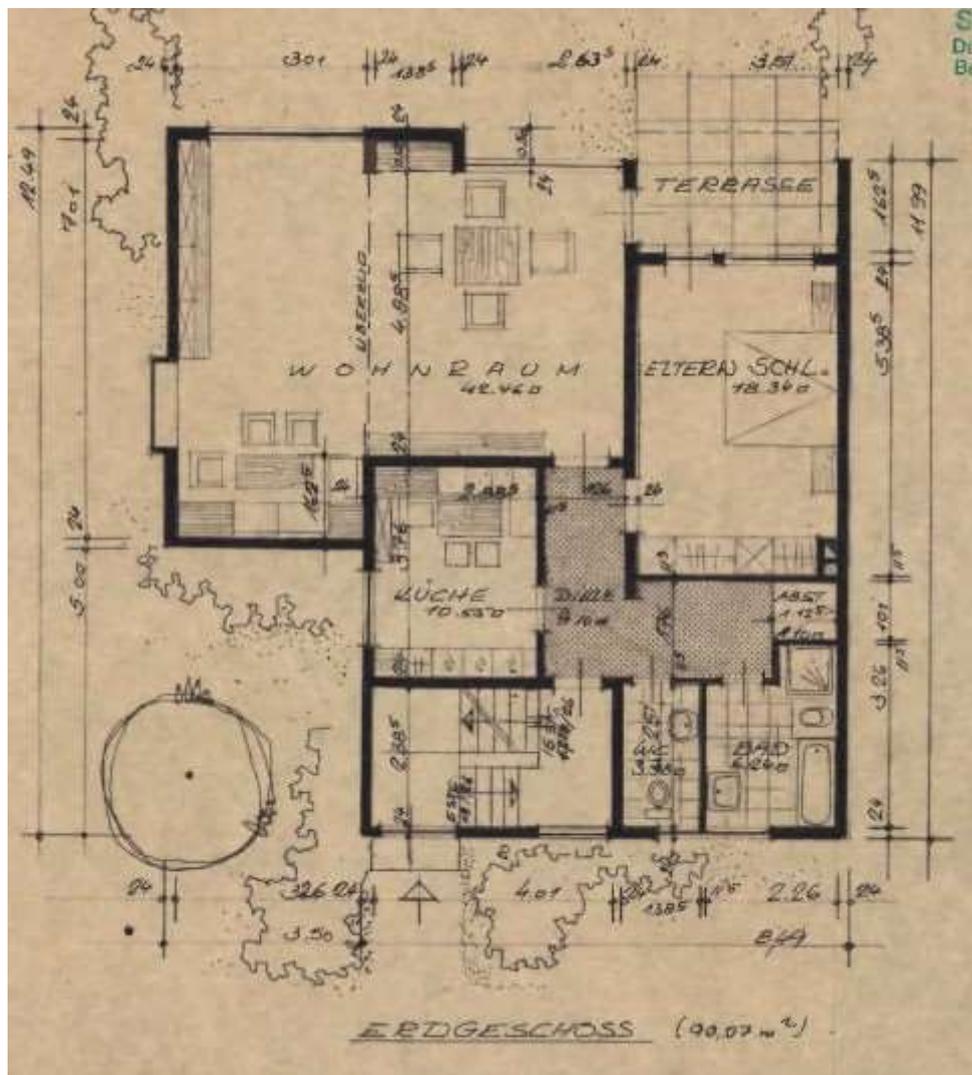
Grundrisse/Ansichten/Schnitt Quelle: Bauakte der Stadt Duisburg
